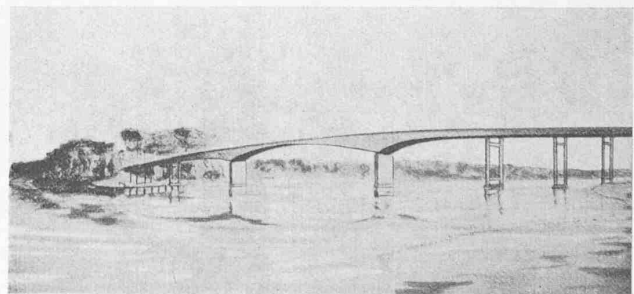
Sandö-Brücke. Ansicht der Eisenbeton-Balkenbrücke über den linken Flussarm. Stützweiten 40—70—40 m, Gesamtlänge 341 m, Betonmasse rd. 4000 m<sup>3</sup>, Stahlbewehrung rd. 500 t
